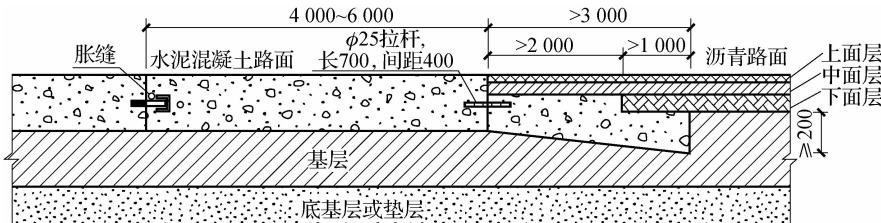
水泥混凝土路面与沥青路面相接段的构造布置(尺寸单位:mm)
